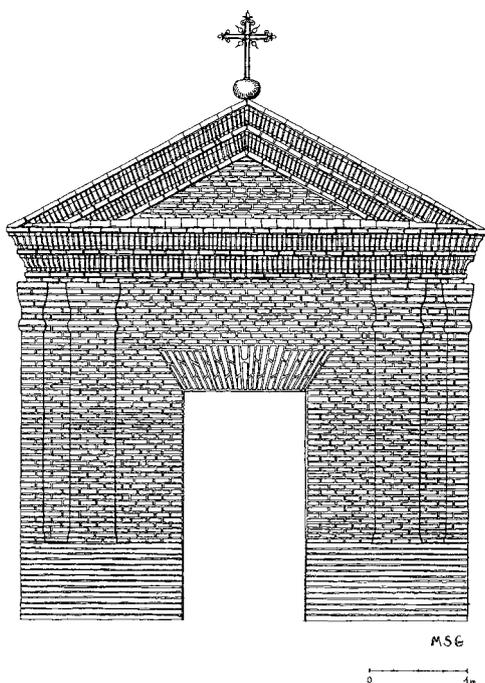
Alzado de la fachada del panteón de Lomoviejo.
